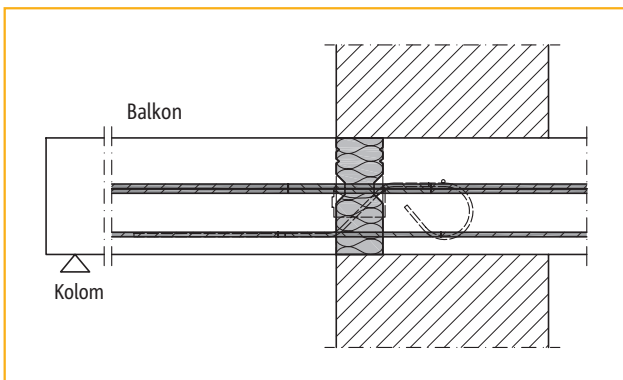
Bovenaanzicht vrij uitkragend balkon met Schöck Isokorb® type K en EQ-module
